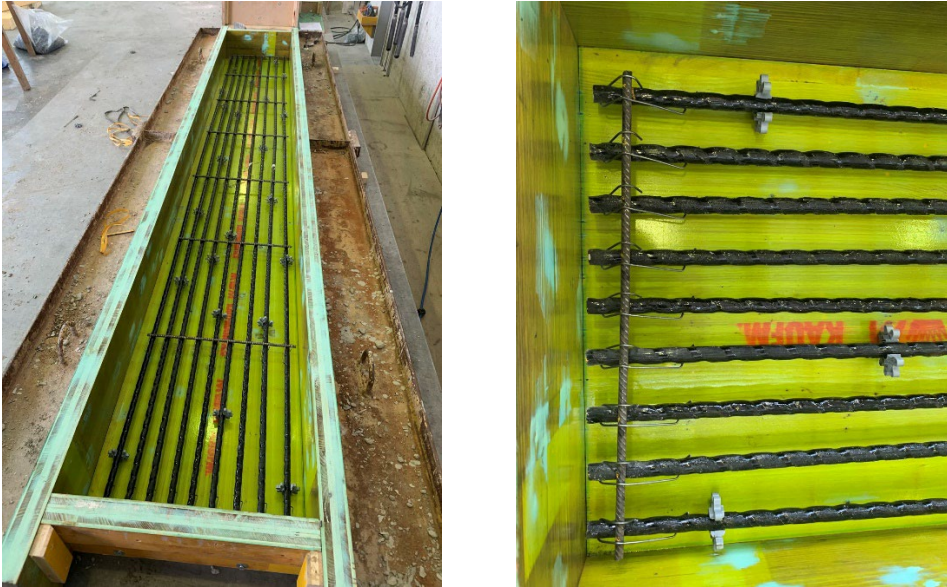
Links: Schalung und Basaltfaser-Bewehrung der Platte 3 vor dem Betonieren. Rechts: Grossaufnahme der Basaltfaserstäbe in der Schalung eingebaut.
